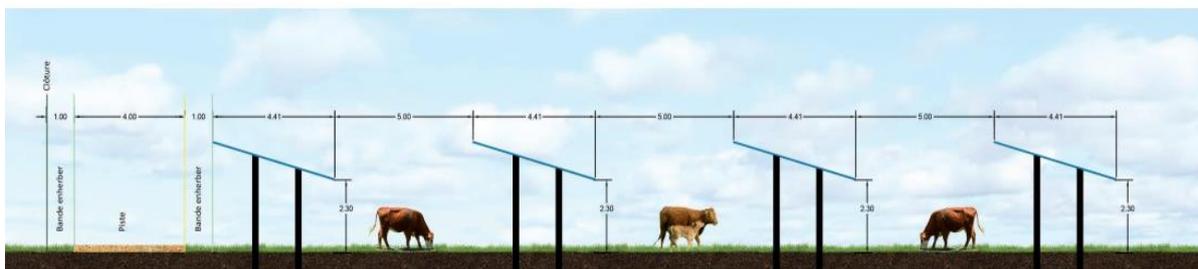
Plan de coupe des structures solaires (source : dossier)
